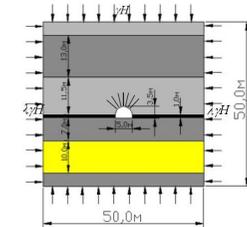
Расчетная схема при решении задачи для выработки, закрепленной рамно-анкерной крепью (7 анкеров)
